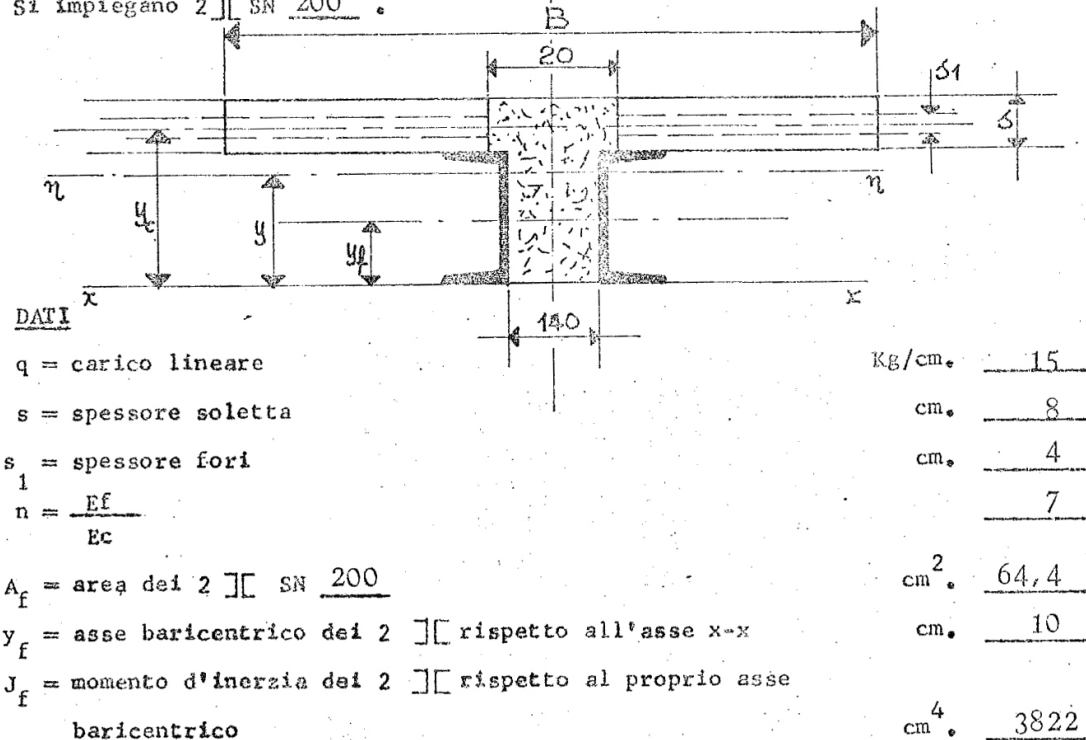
Estratto del progetto originale: sezione tipo travi solaio copertura.
